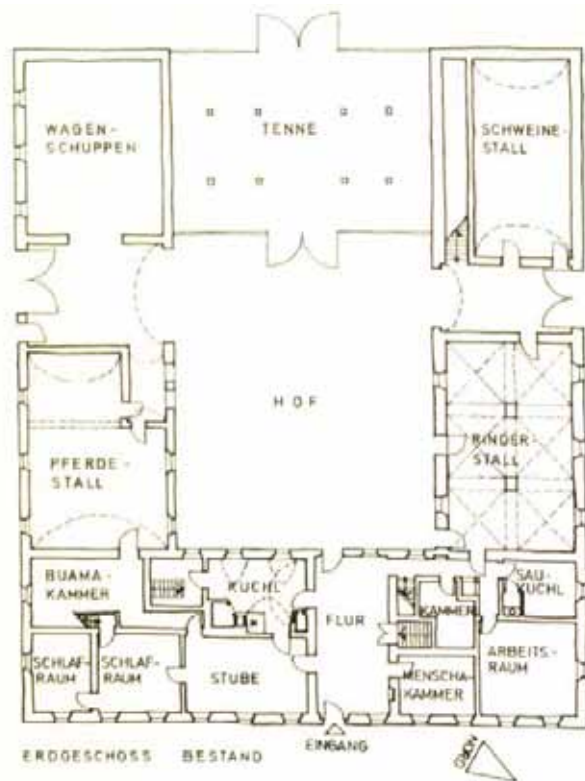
Grundriss Vierkanthof EG (Spielhofer 1981, S.80)
